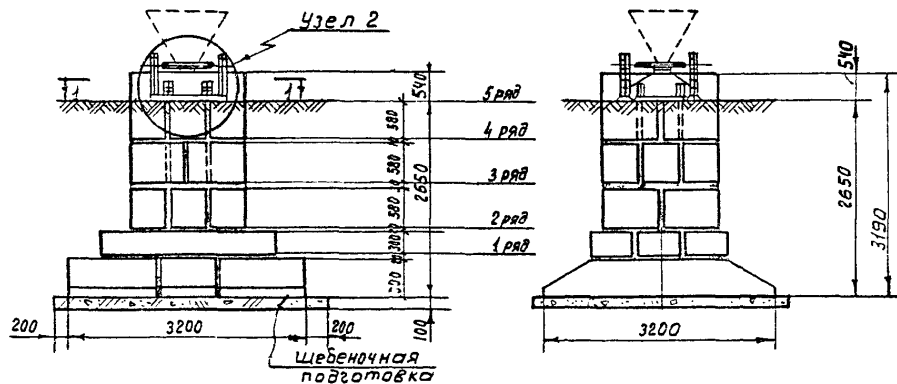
Рис. II. Сборный железобетонный центральный фундамент мачты ЦФ-I
